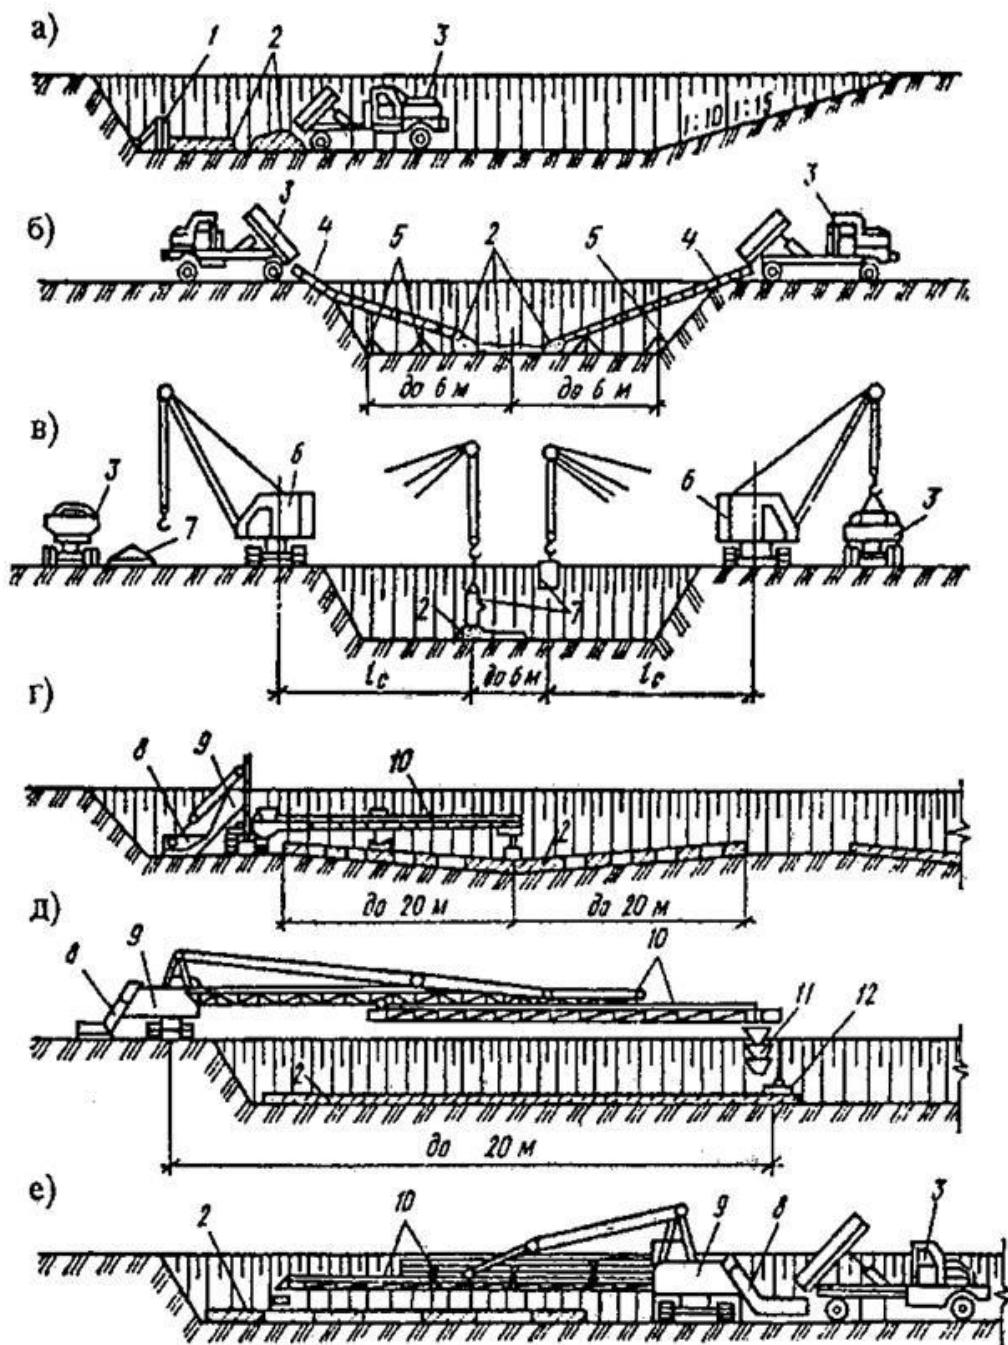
Схема устройства щебеночной и бетонной подготовки под днище емкостных сооружений: 1 – опалубка, 2 – щебень или бетонная смесь, 3 – автосамосвал, 4 – виброжелоб, 5 – опоры, 6 – кран, 7 – бадьи, 8 – скраповой подъемник, 9 – бетоноукладчик, 10 – конвейер, 11 – хобот, 12 – вибратор
